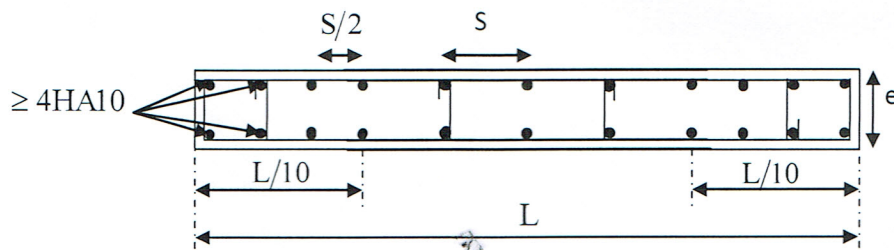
Disposition des armatures verticales dans les voiles.
